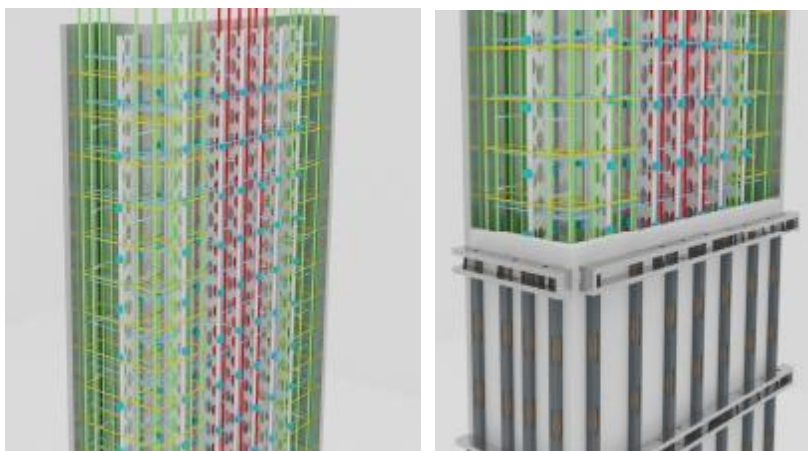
M 型钢成型钢筋骨架剪力墙
